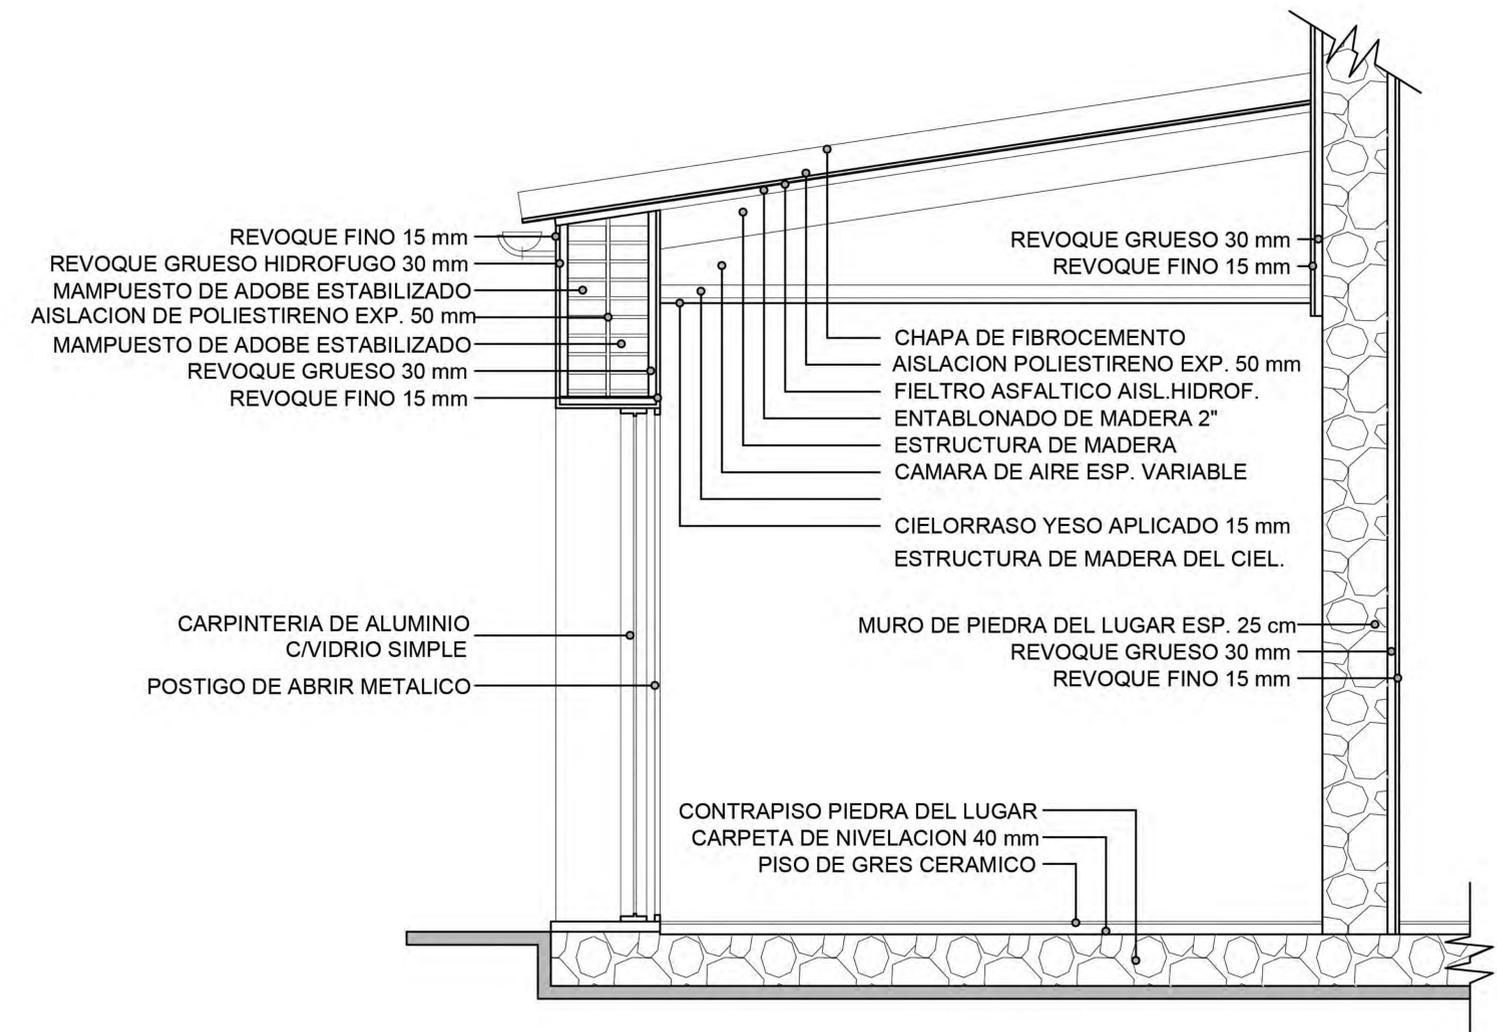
Sistemas constructivos de las envolventes del Caso 01. Elaboración propia
